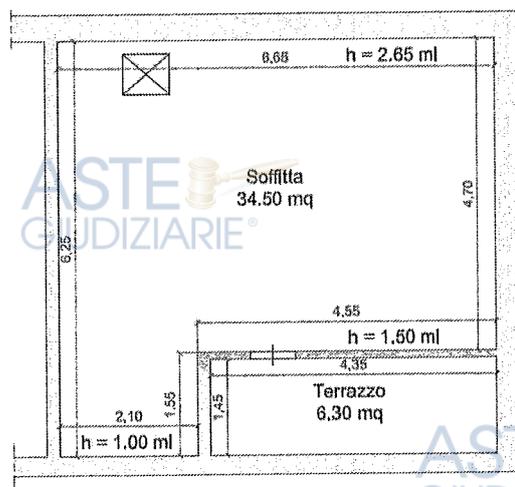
Planimetria Catastale Foglio 47, p.lla 1394, sub 12 – Piano 1
